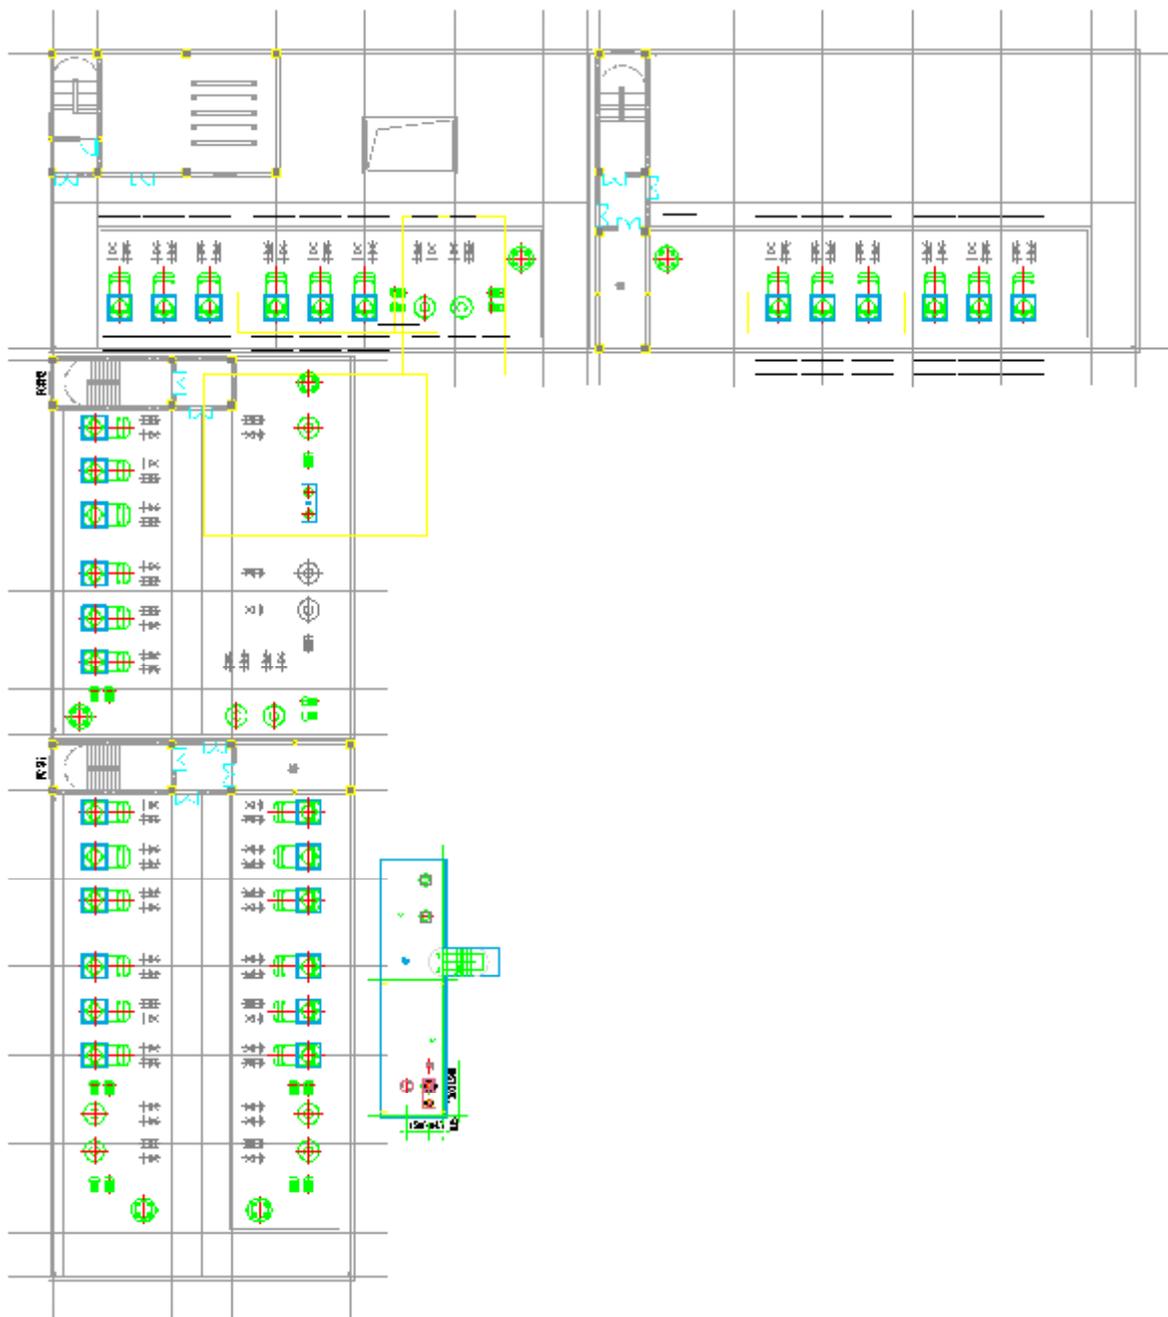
改扩建后甲类车间屋顶平面布置图
